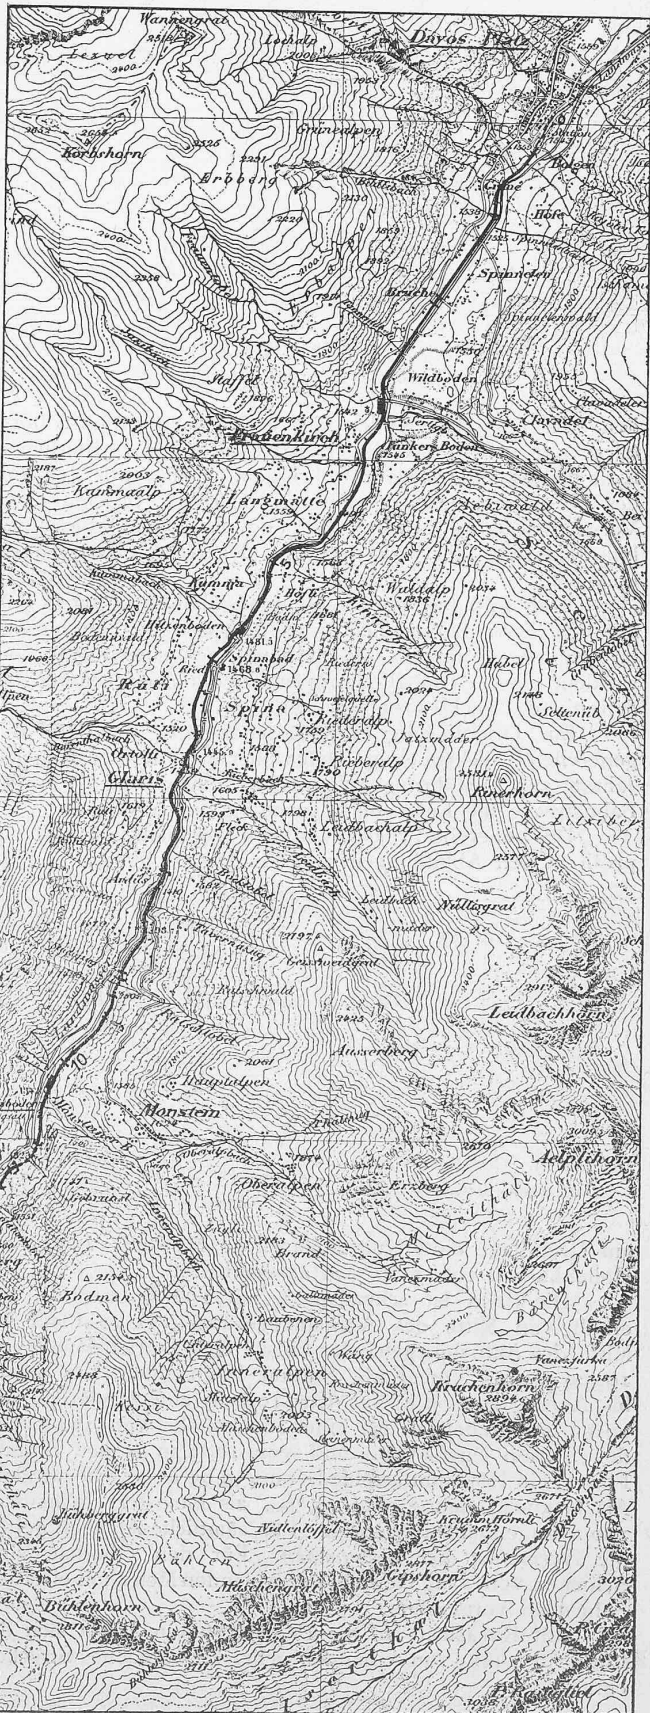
Lageplan. — Masstab 1 : 60 000.
